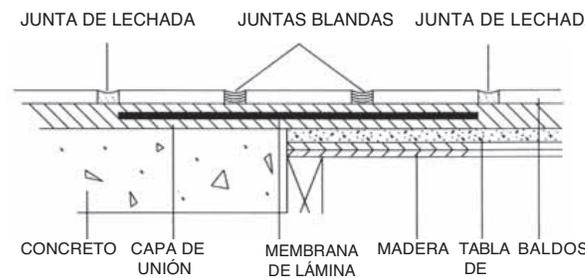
AISLAMIENTO DE GRIETAS - COBERTURA PARCIAL
